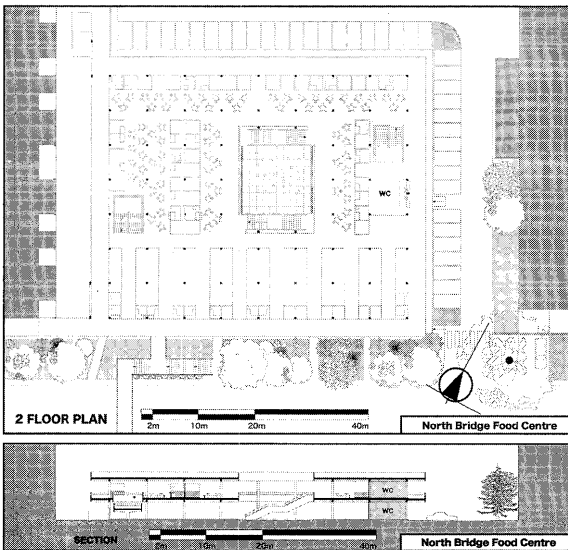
(左列):再配置時代の(18)North Bridge Food Centreの平面・立面図
